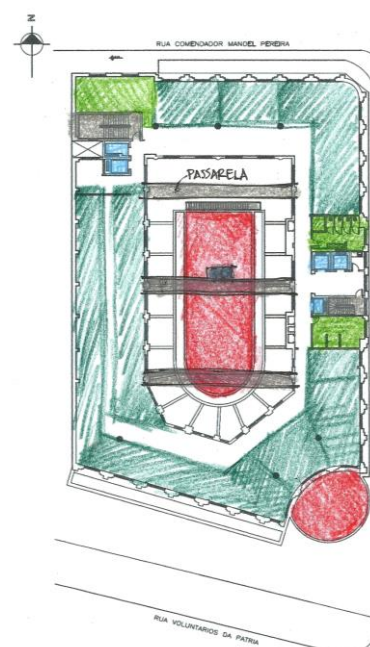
Planta Baixa Cobertura - Mapa de Manchas com zonamento da proposta de intervenção.
